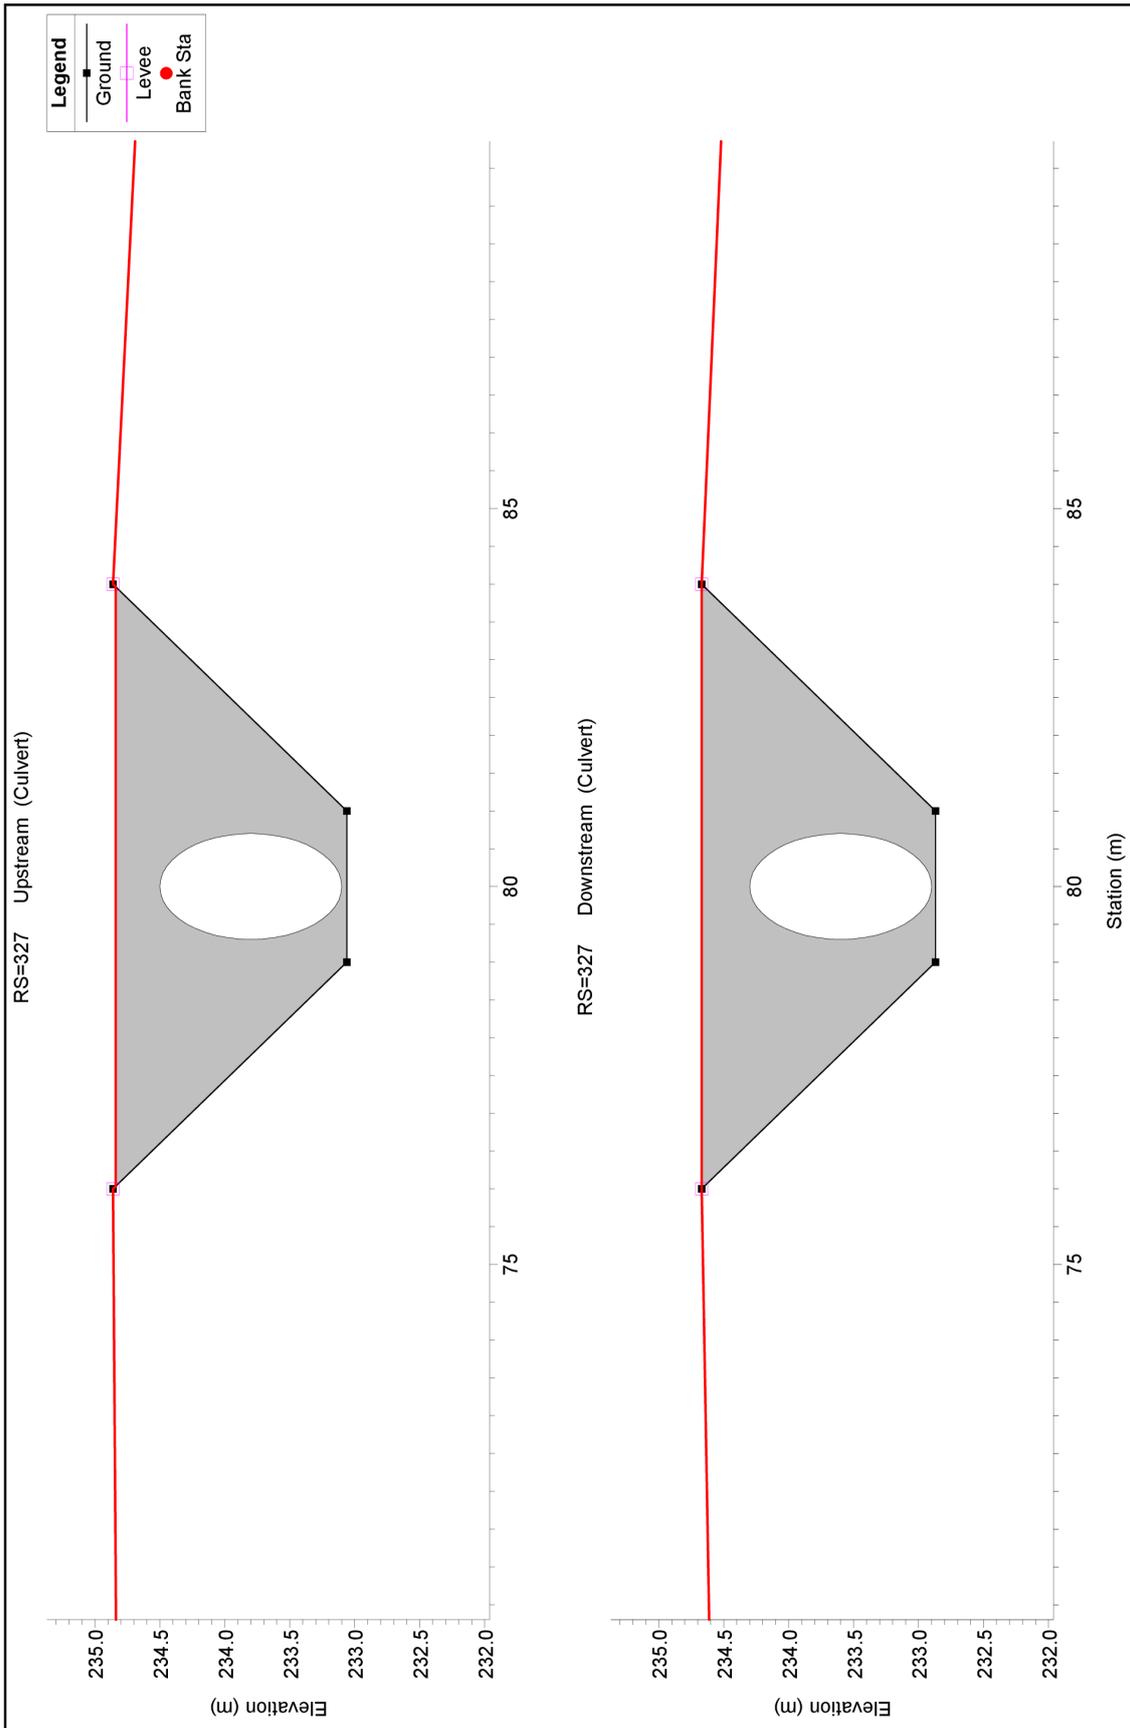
Modellazione in HEC-RAS Canale tombato a sezione circolare (RS = 327)
